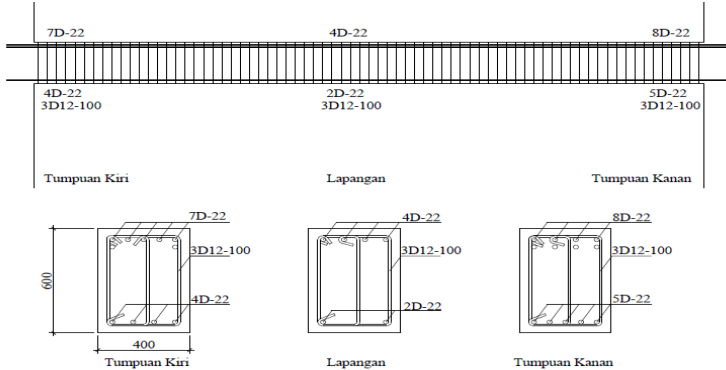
Detail tulangan untuk penyaluran kait standar
